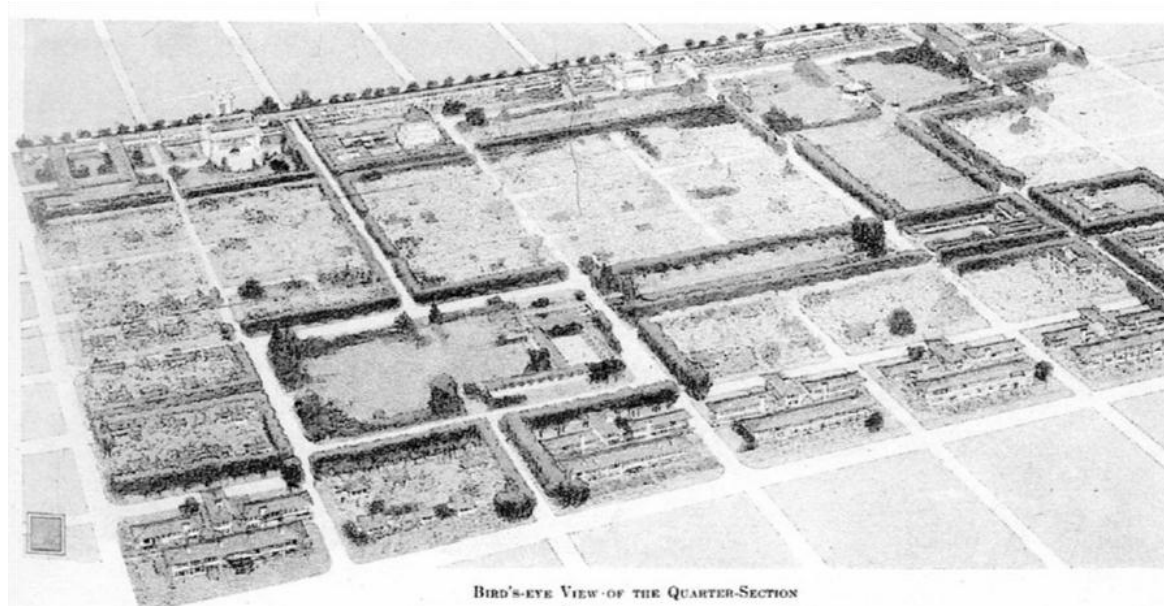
Planta de conjunto de la City Residential Land Development en Chicago 1915. Fuente: (De Long D. , 1998). pag.21
